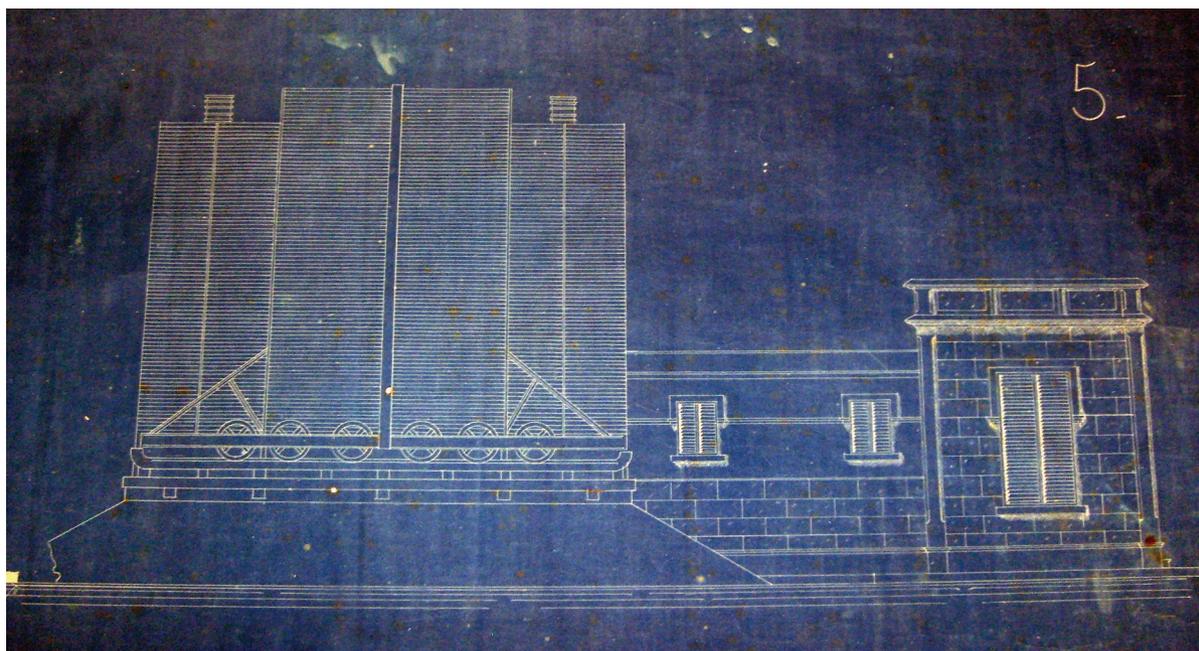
Fachada lateral. Desenho original do pavilhão da luneta meridiana de Gautier. Arquivo MAST, Rio de Janeiro.
